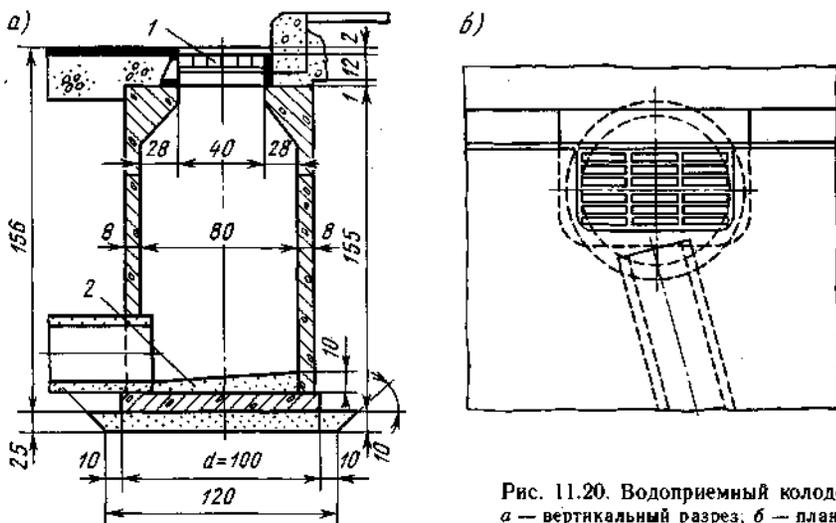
Водоприемный колодец: а — вертикальный разрез; б — план
